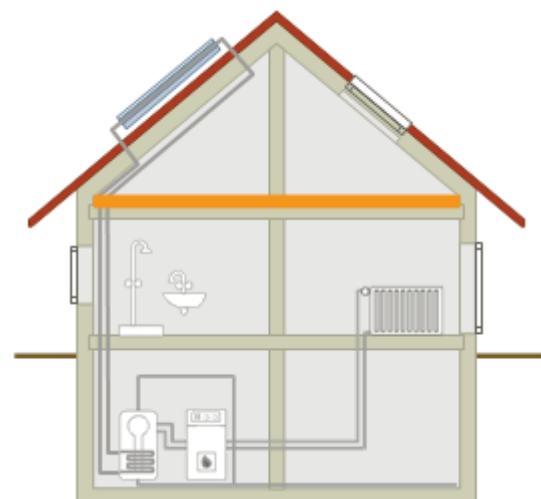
Теплоизоляция крыши на верхнем этаже / наклонная крыша
